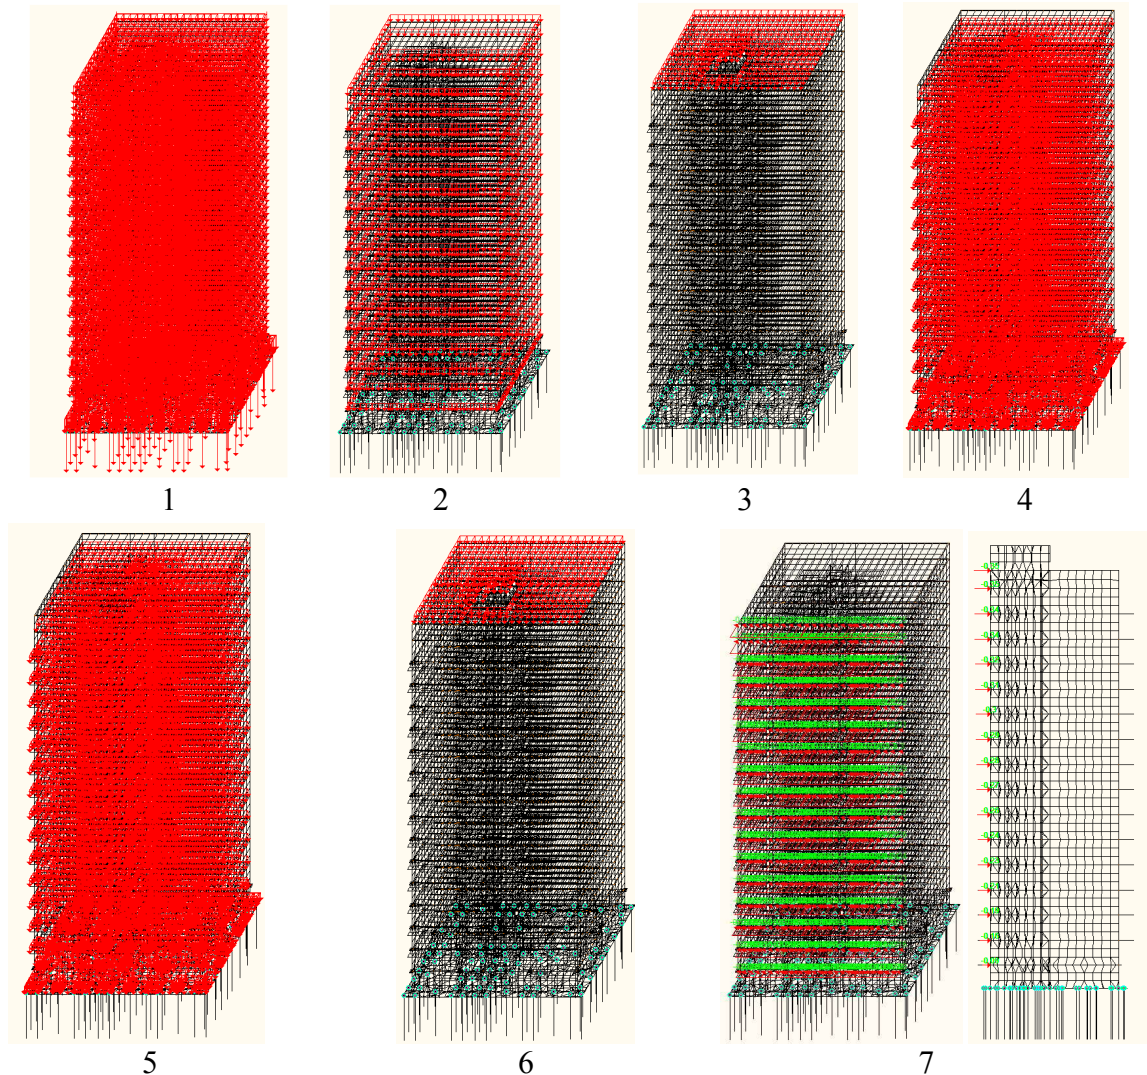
Нагрузка от: 1-собственного веса конструкций, 2-собственного веса стеновых панелей, 3- собственного веса кровли, 4- собственного веса полов, 5- собственного веса временных перегородок, 6- снеговой нагрузки, 7-ветровой нагрузки
